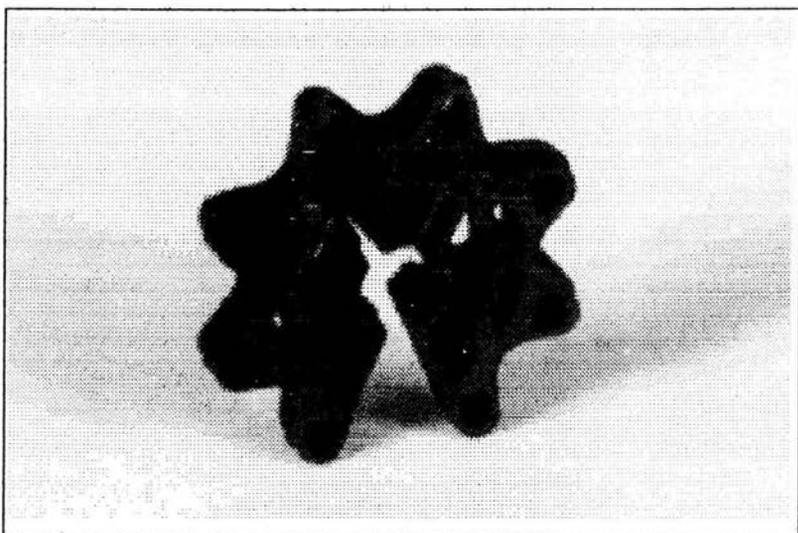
En la figura se muestra un separador de varilla de refuerzo de entrecalles de paneles de losa de azotea y entrepiso.
